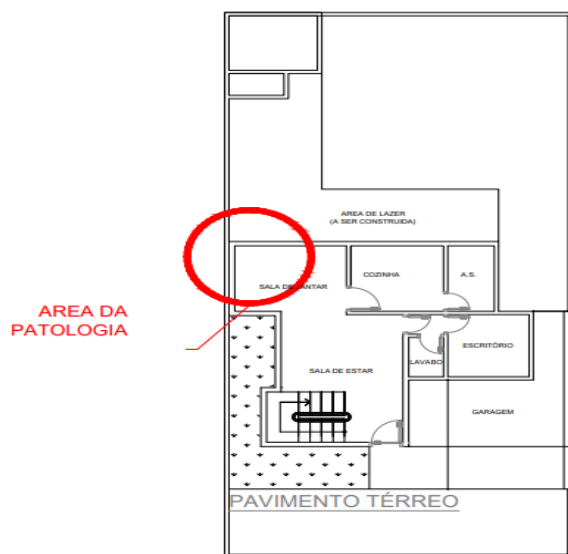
Planta baixa da estrutura com destaque no ponto de maior concentração da patologia.
